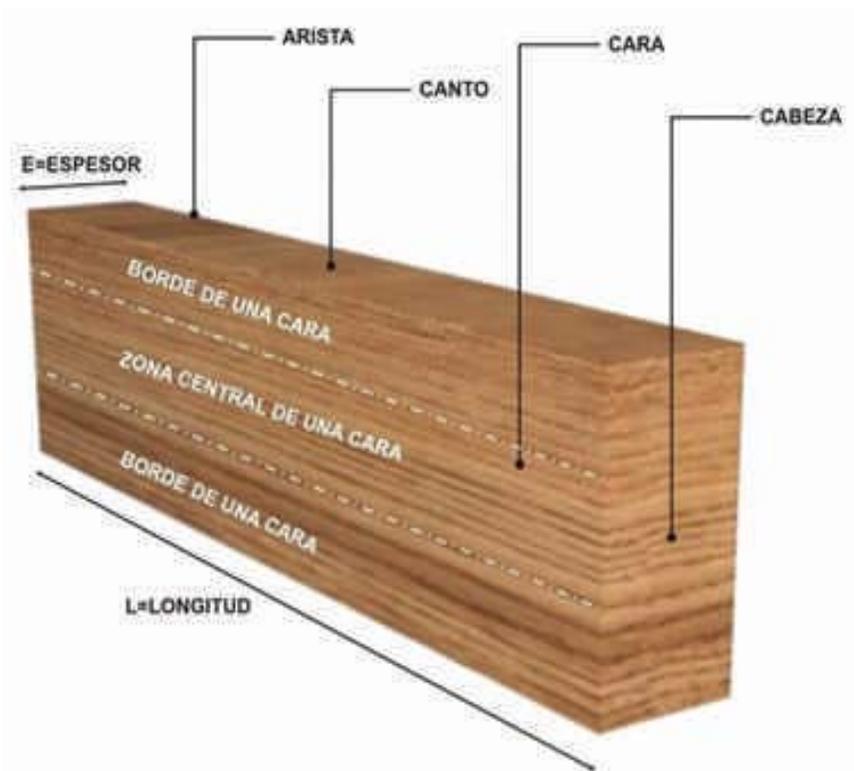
Términos utilizados para definir la geometría de una pieza de madera.
